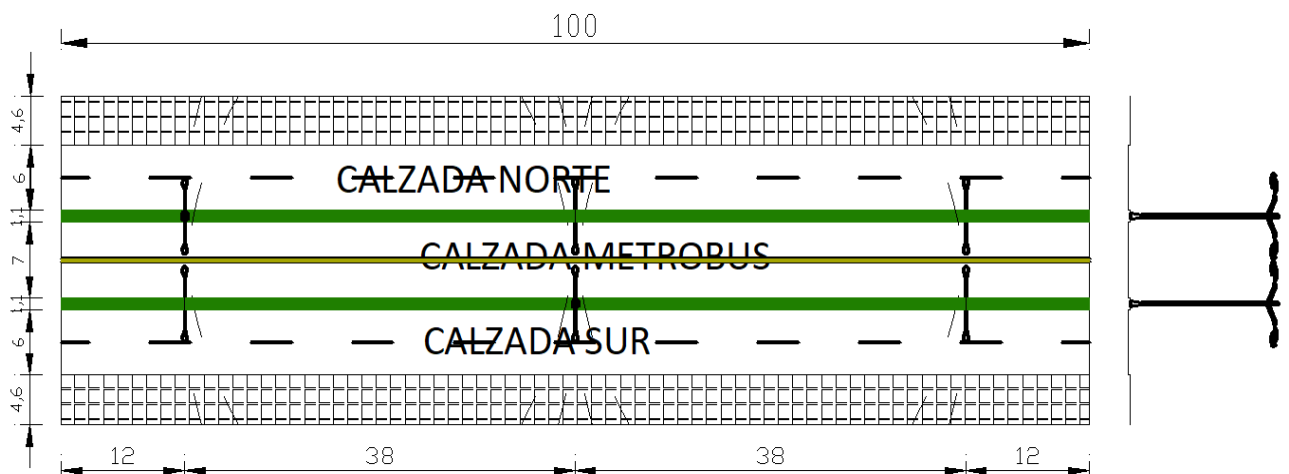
Detalle disposición de luminaria cuadra tipo N°3 y N°4. (Fuente: elaboración propia)
